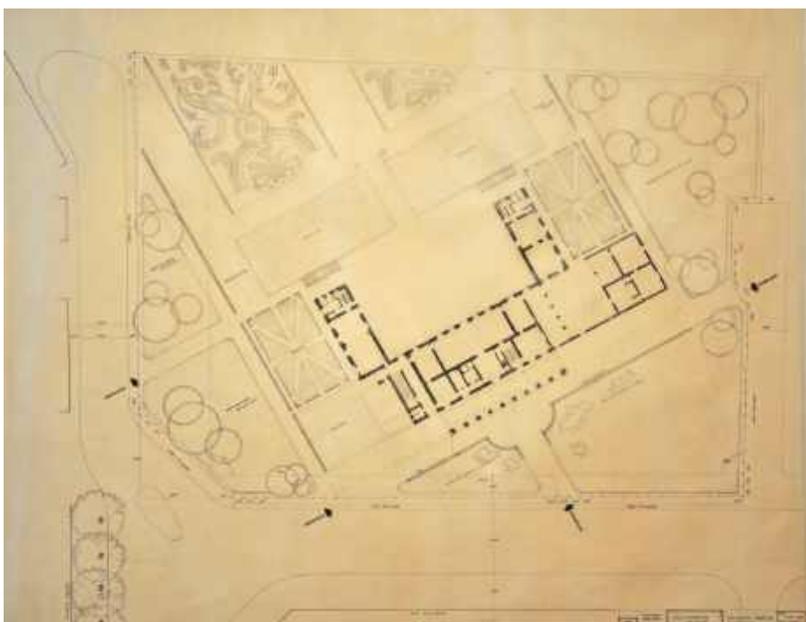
Pianta piano terra e giardino, tavola di progetto su lucido
